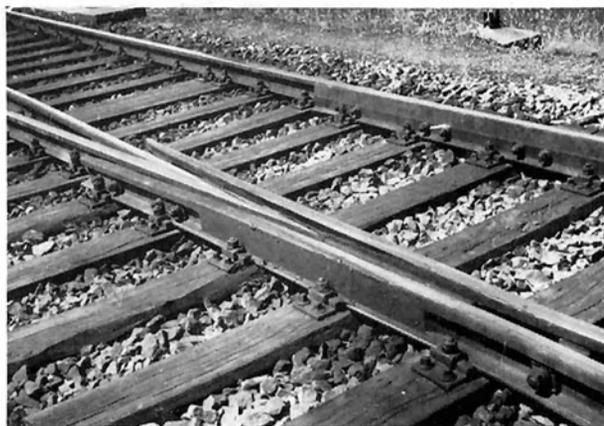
Herzstück mit eingeschweißtem Mittelblock; Konstruktion der Fa. Bochumer Verein
